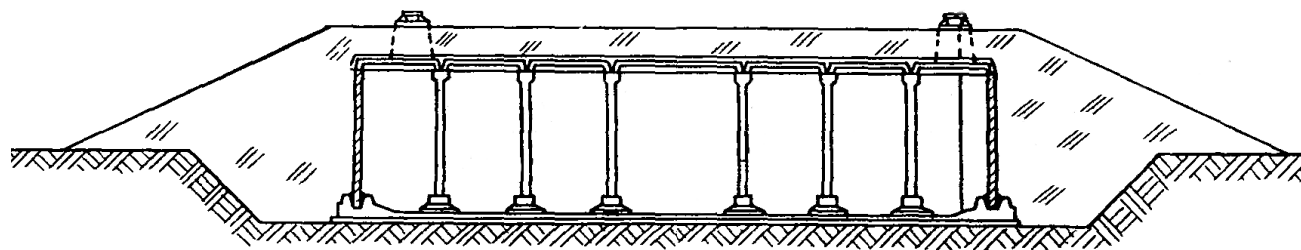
Эскиз общего вида резервуара ЖБР-5000
